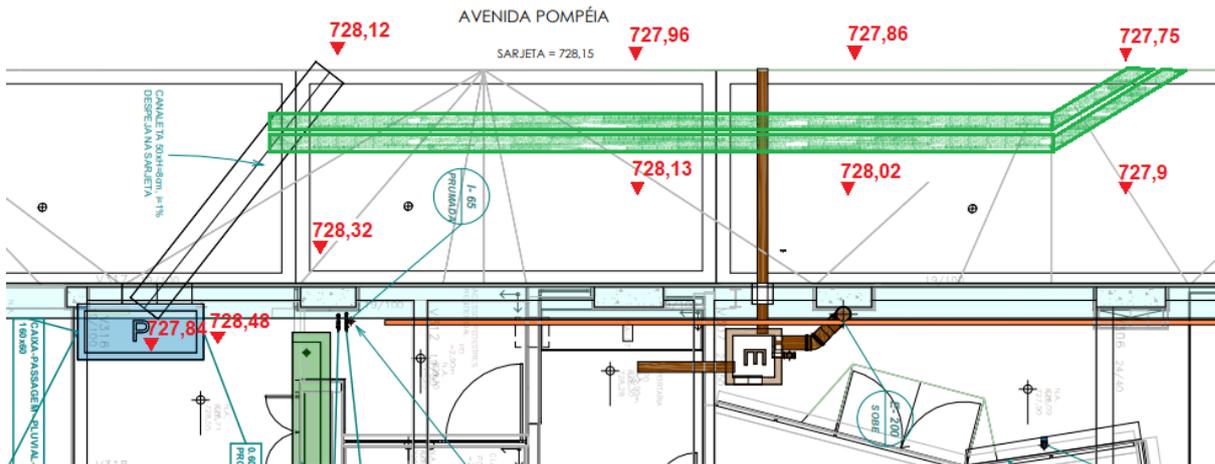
Rascunho executado pelo projetista, caminhando a tubulação pelas vigas
